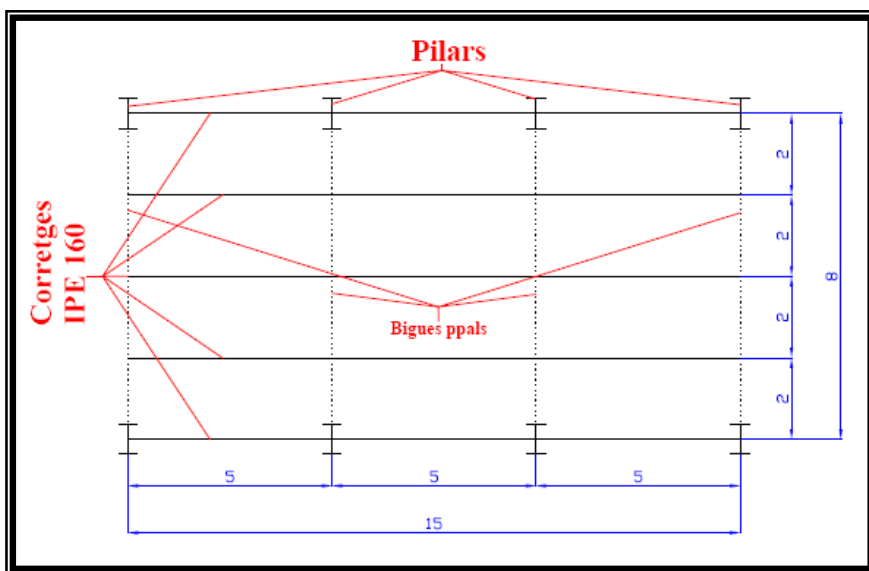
Planta tipus de l'estructura. Distàncies en metres.
